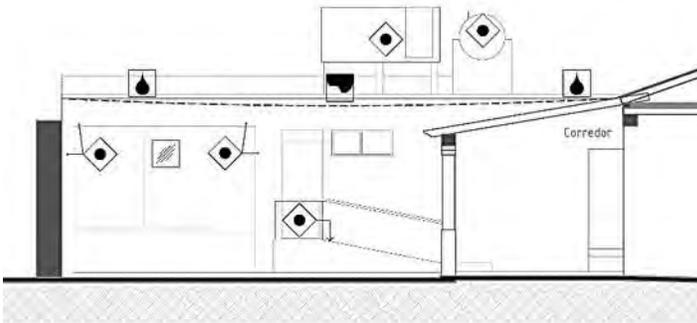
Croquis interior de anexo sur donde se observan la flexión de la losa, así como las múltiples alteraciones y deterioros principales. Elaboró: AMT.
